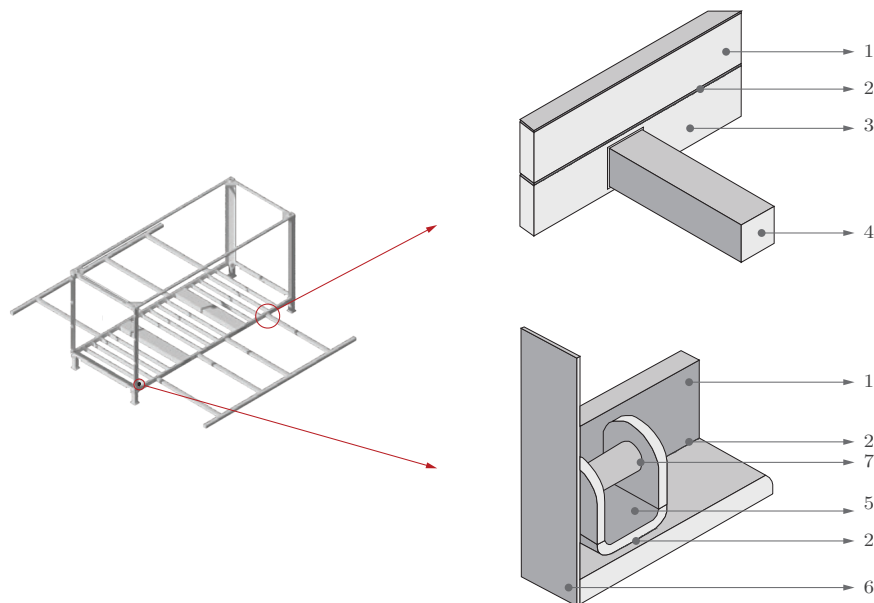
Detalle constructivo del sistema de muros del contenedor EMH. Fuente: Ramón (2015). Elaboración: Autores.
